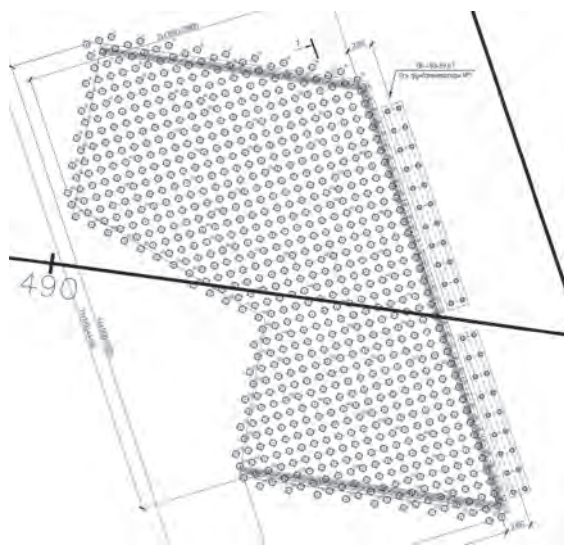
Фрагмент плана щебеночных элементов под подпорную армированную стенку
